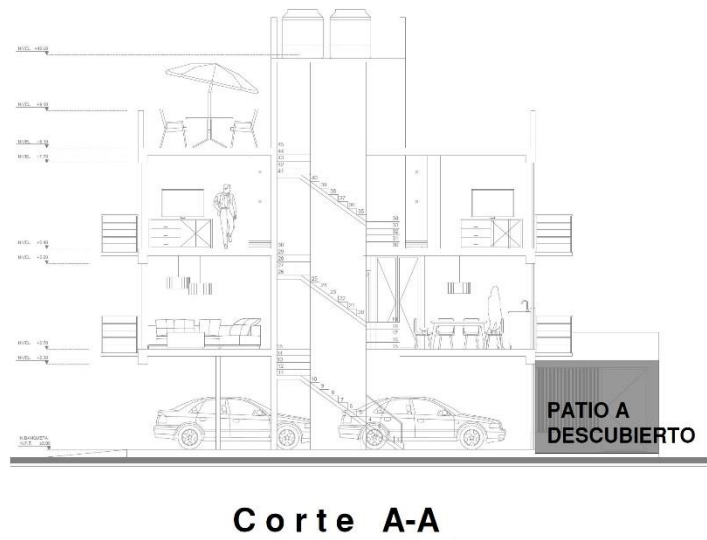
Corte esquemático, Planta Baja, patio a descubierto.
